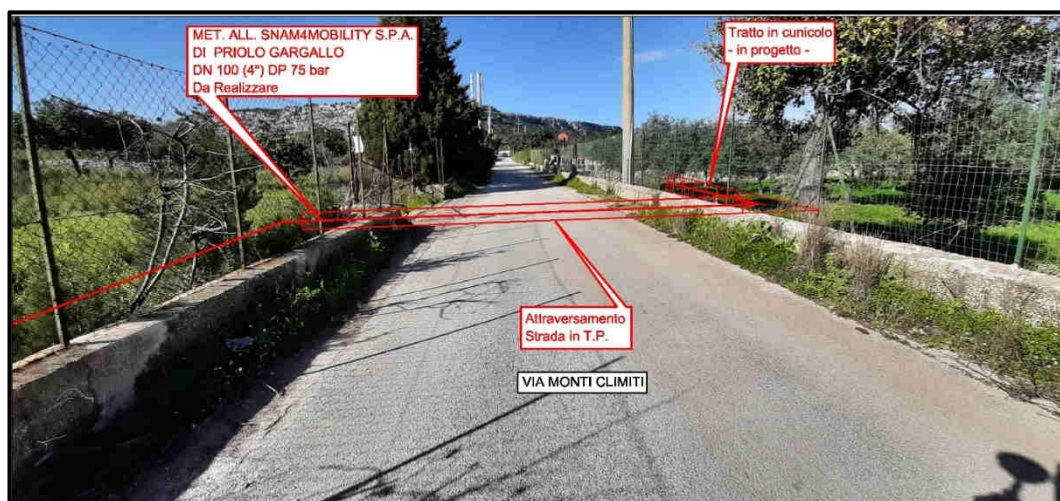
Vista Met. in progetto, Attraversamento via Monti Climiti in T.P.
